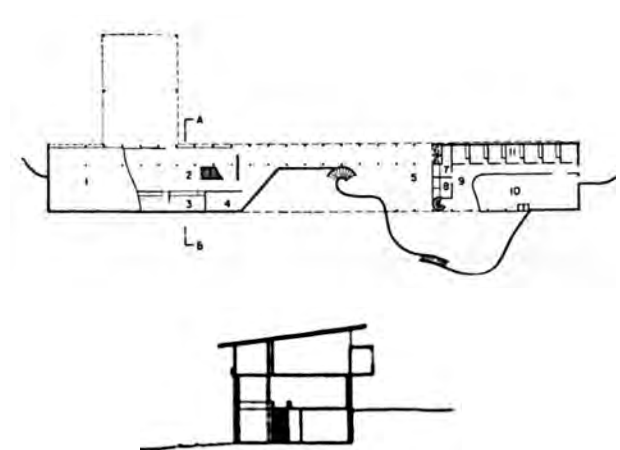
MM Roberto: Colônia de Férias do IRB, Rio de Janeiro, 1944. Planta do andar principal e corte transversal. [MINDLIN, 2000]: 130
